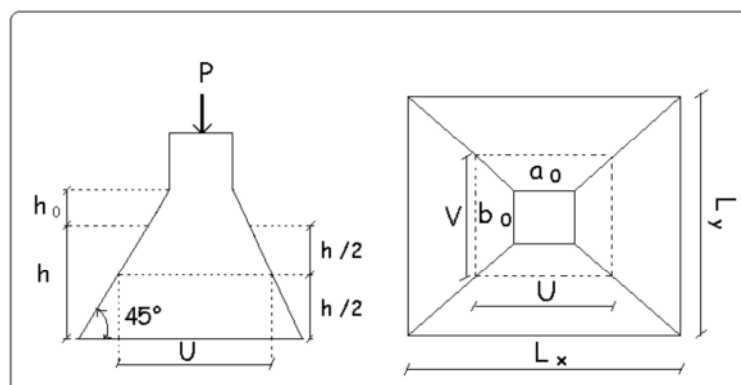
Schéma de la dalle d'ascenseur et sa surface d'impact
